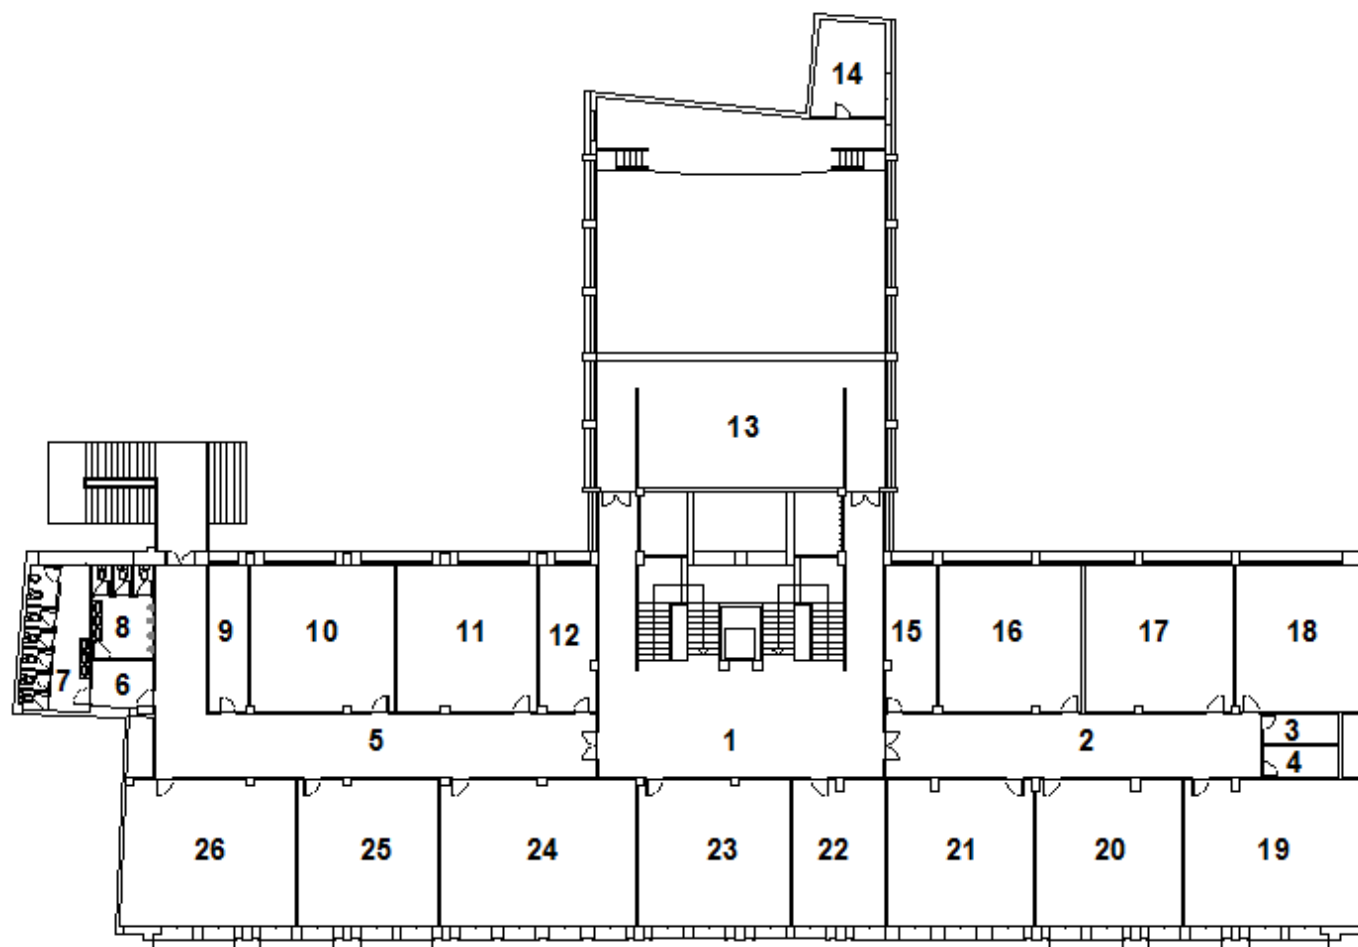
Distribución planta primera. Fuente: Elaboración propia.
